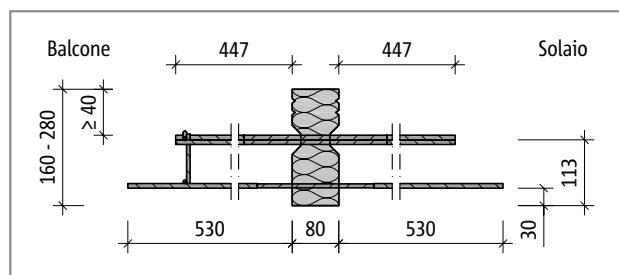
Schöck Isokorb® tipo EQS, sezione del prodotto
